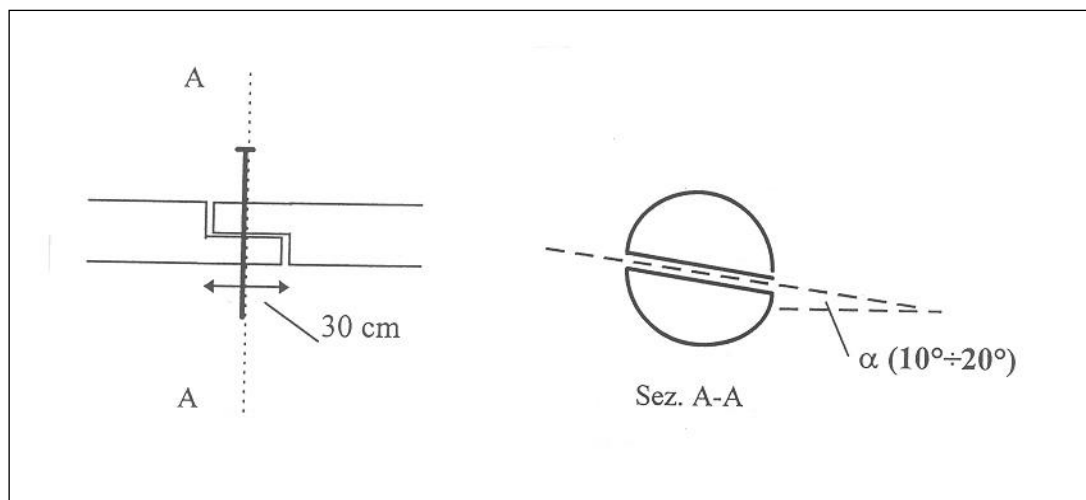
Particolare del collegamento tra elementi longitudinali.
